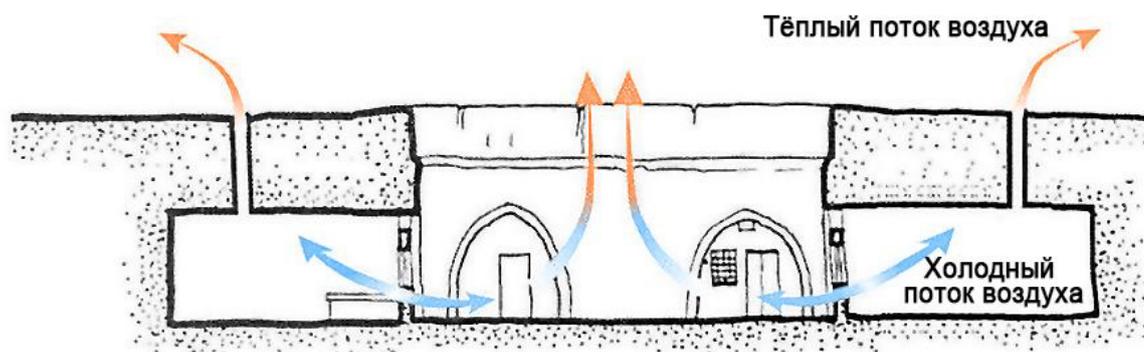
Схема вентиляции яо-дуна с вентиляционными каналами (схема Чжан Имэн)
